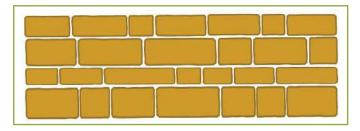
Schéma d'un muret où les pierres sont montées en appareillage assisé (Dessin de Cédric Houel)
